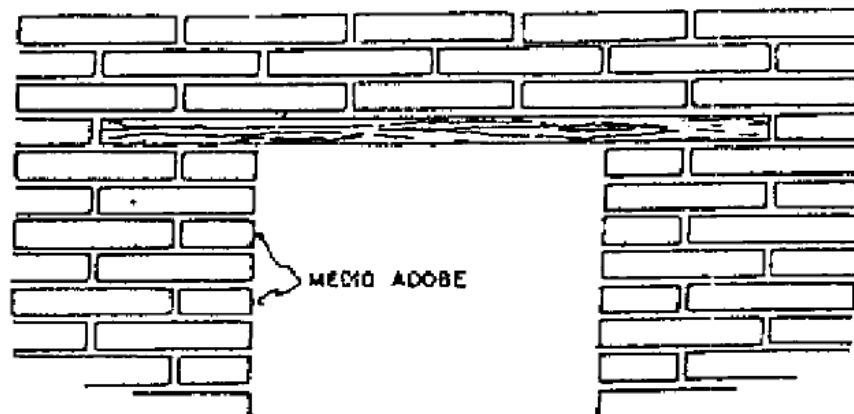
DETALLE DE MEDIOS ADOBES EN MUROS
